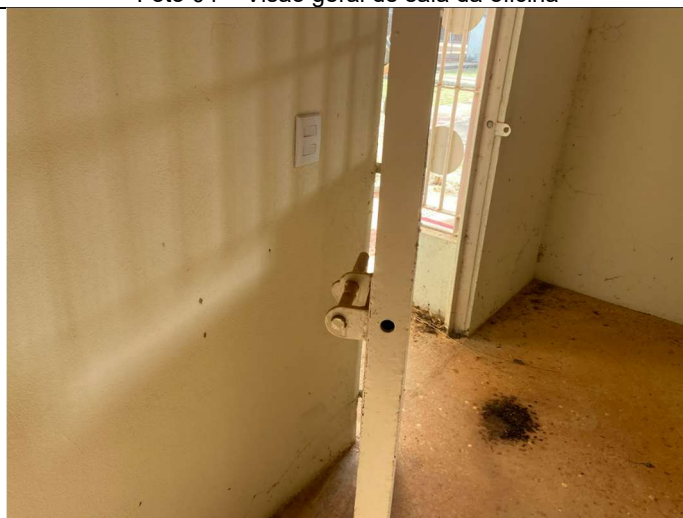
Detalhamento de ferrolho para o lado de dentro
